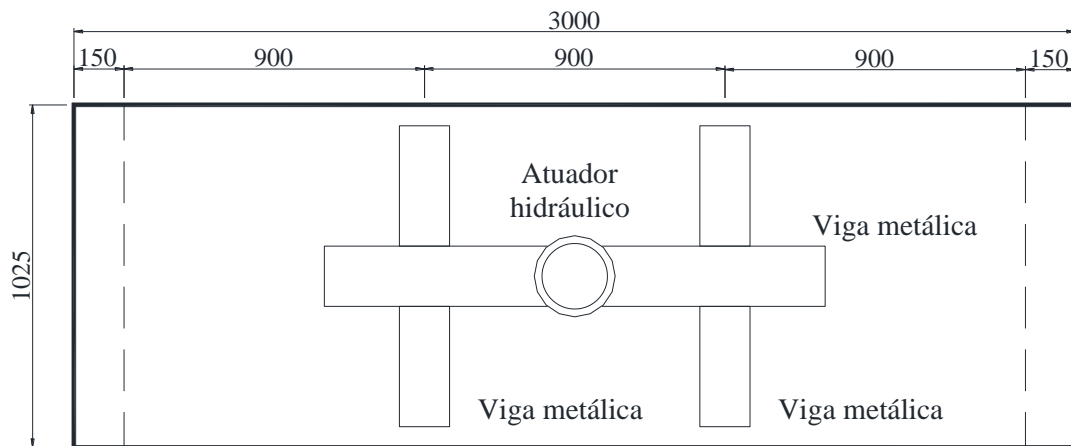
Vista superior do sistema de ensaio (dimensões em mm).
